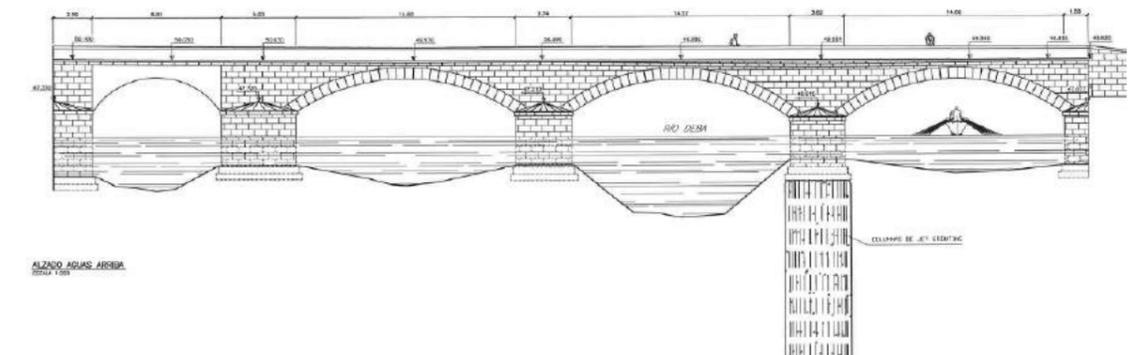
Plano del alzado de aguas arriba obtenido del proyecto de reparación de 2002 (referencia [3]). Se observa la solución planteada para la pila 1 utilizando jet grouting.
